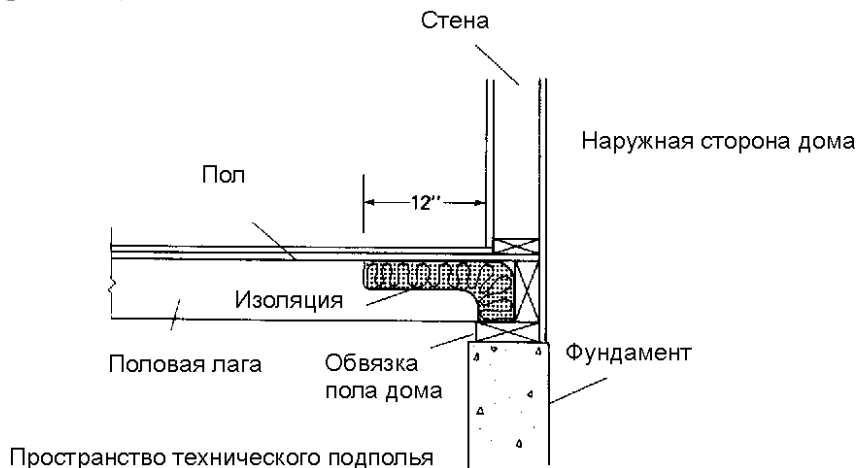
Теплоизоляция в местах примыкания пола к наружной стене
